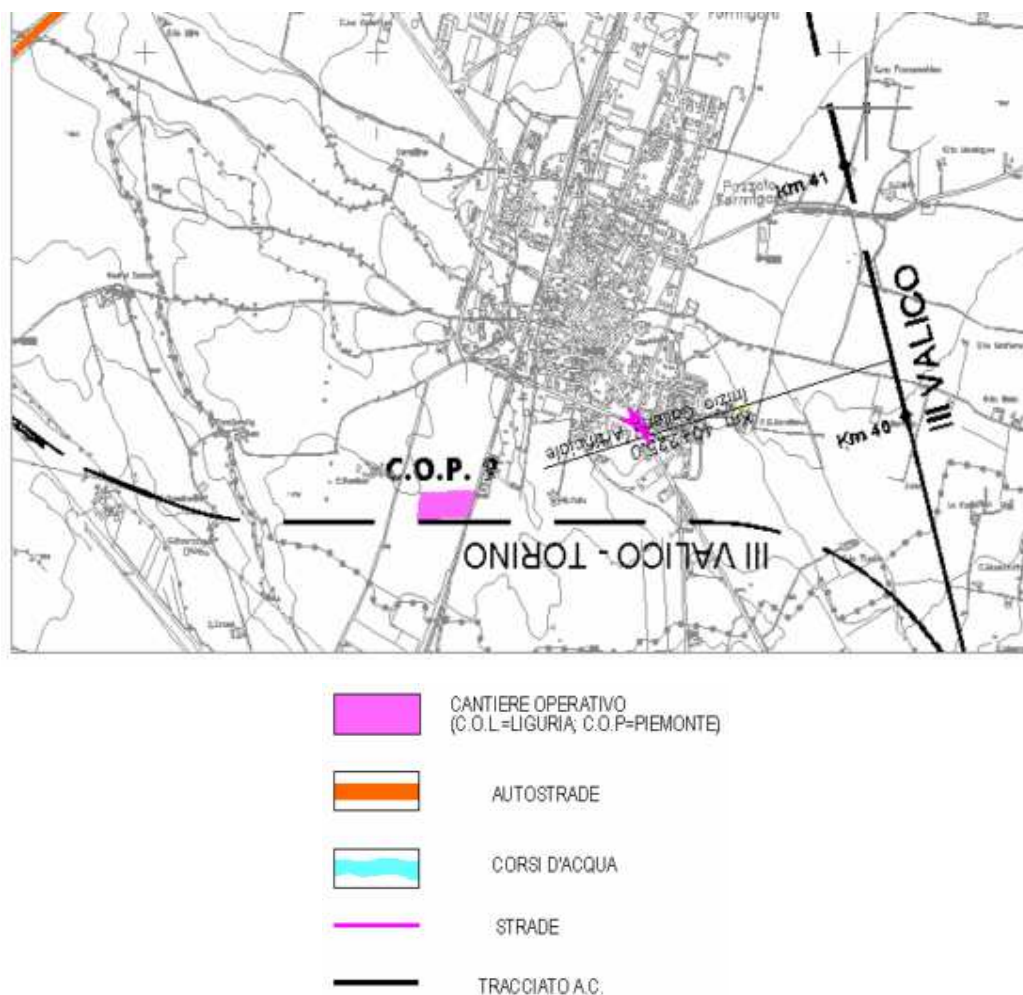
Stralcio planimetrico con indicazione dell'ubicazione del cantiere Operativo C.O.P.9 per la soluzione di Progetto Definitivo
